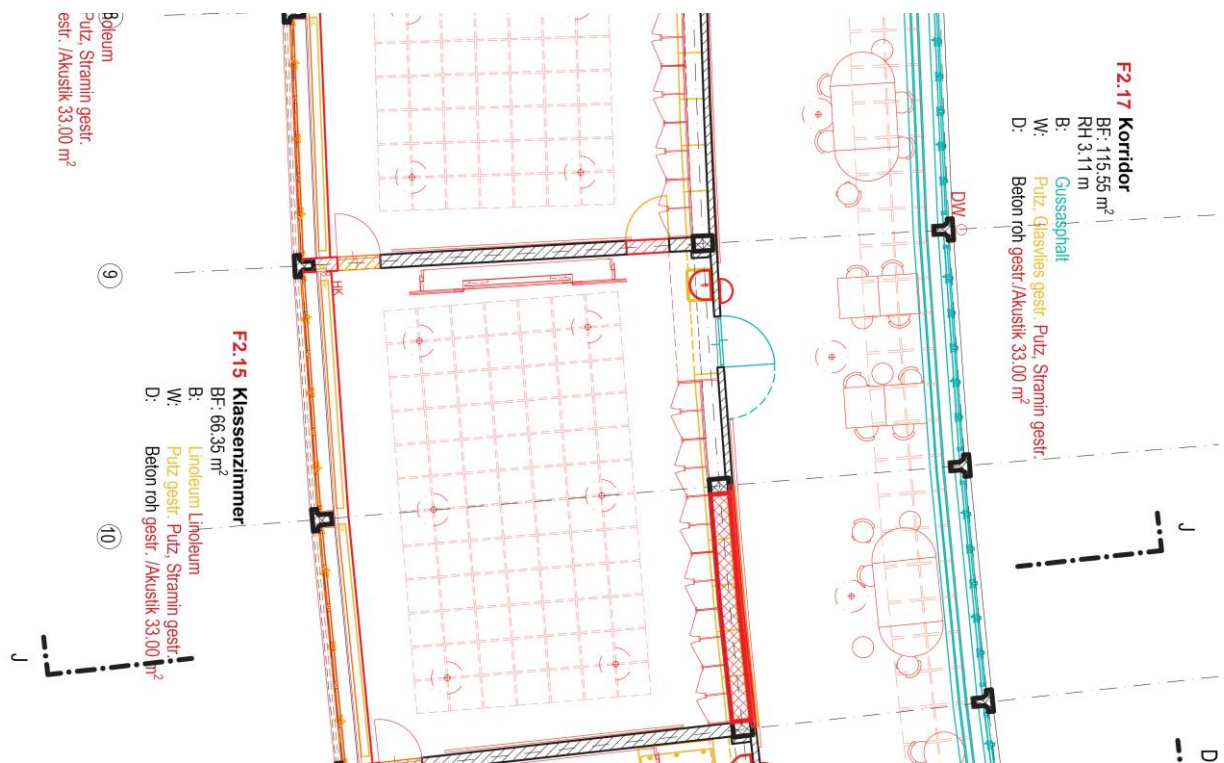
Grundriss Regelklassenzimmer und Korridor
